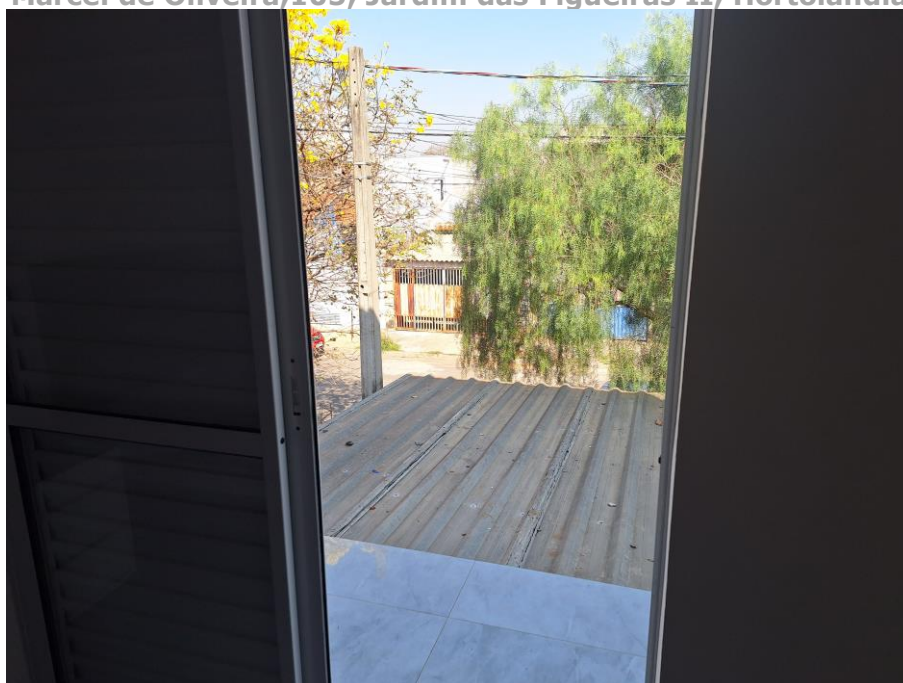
Vista Interna – SACADA. Sacada da suíte. Piso porcelanato. (Obra não finalizada). Vista para coberturas e áreas do piso inferior (térreo). Acesso franqueado pelo Executado.
